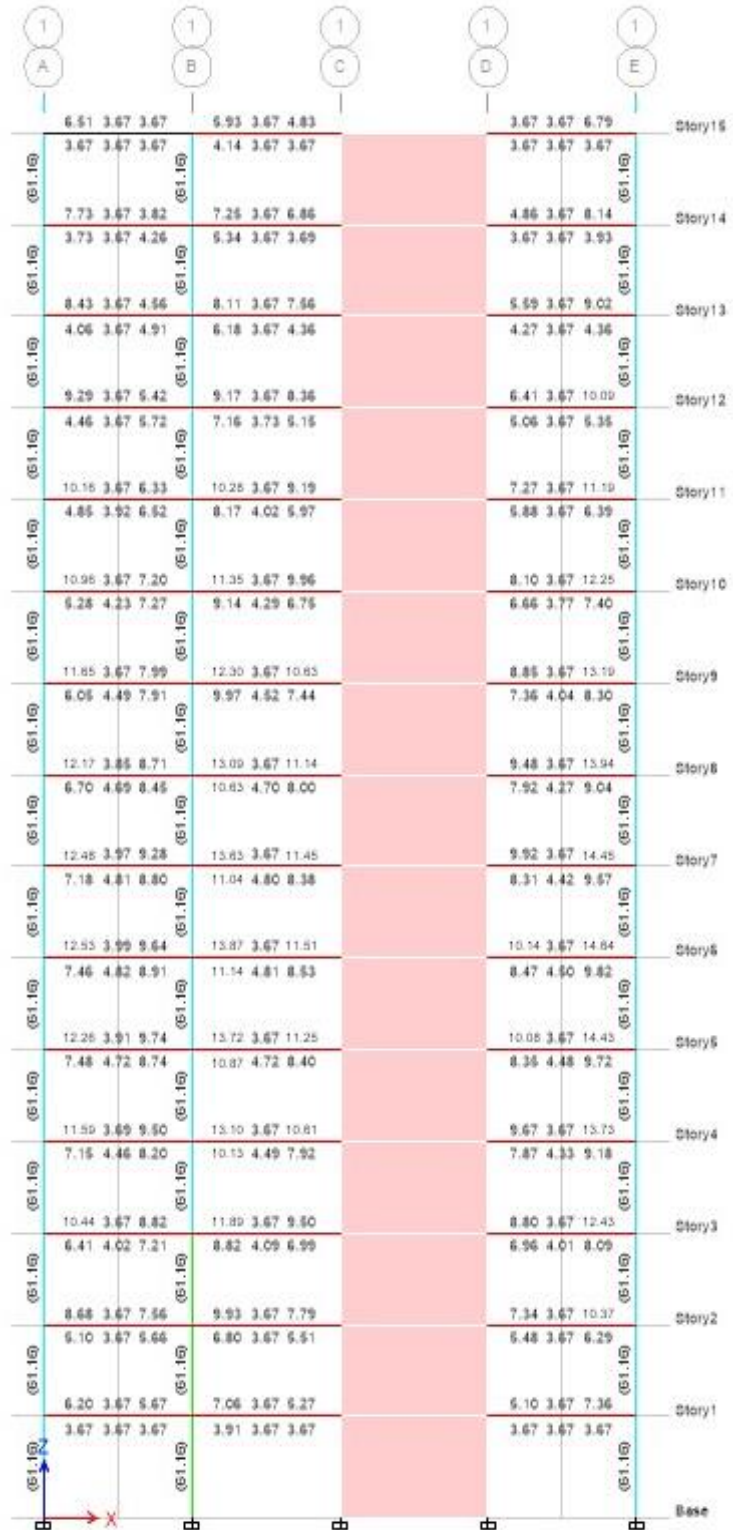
Respuesta de diseño de columnas con 12 varillas de 1" en la elevación 1
